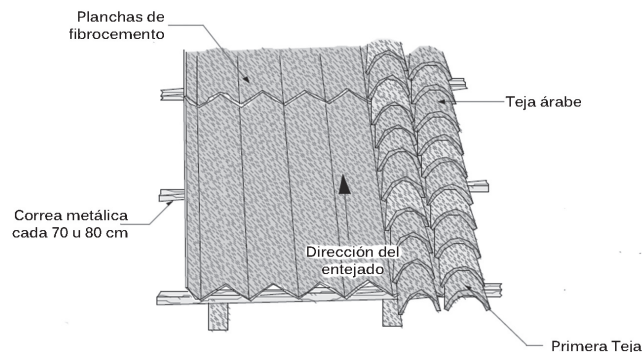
Detalle del revestimiento de la cubierta metálica con planchas de fibrocemento y teja árabe.
